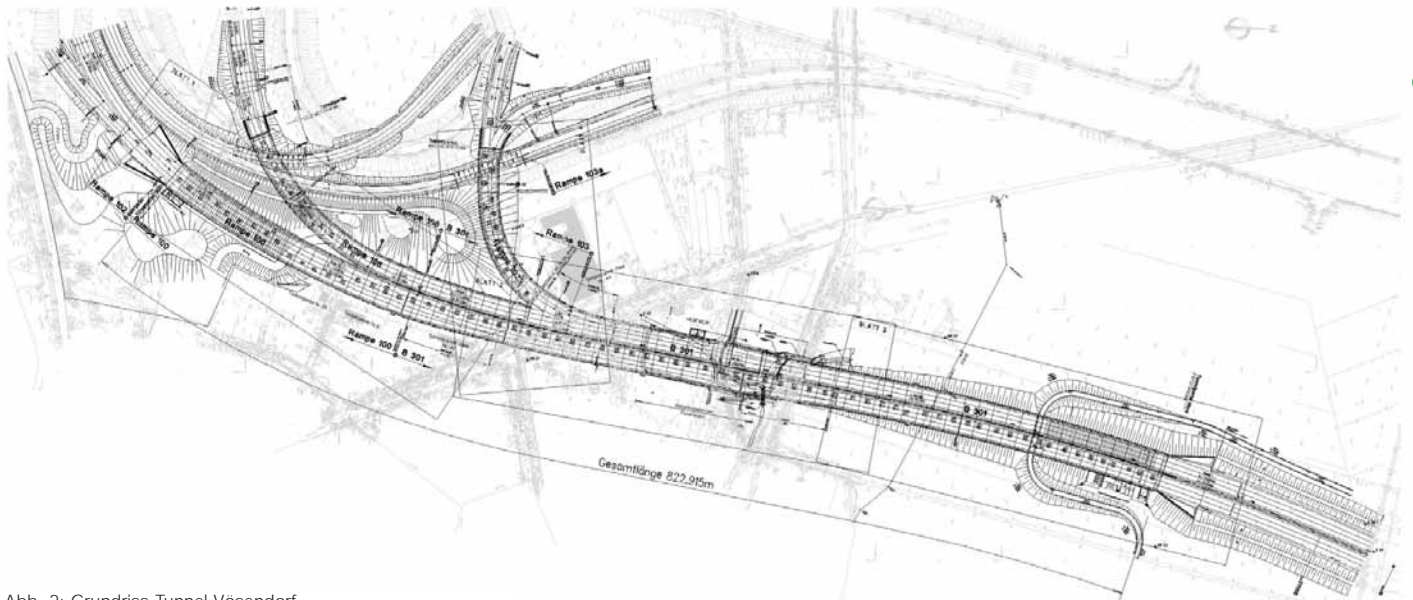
Grundriss Tunnel Vösendorf
